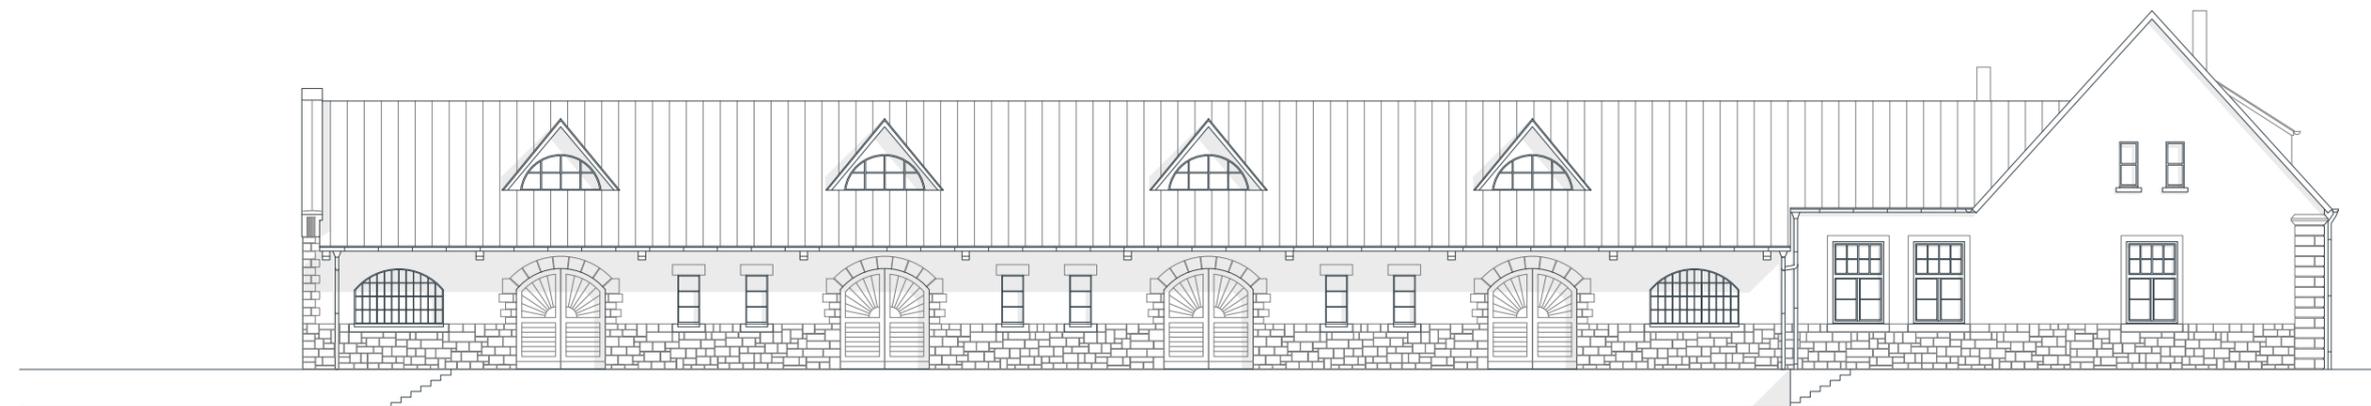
Zollabfertigung mit Zollschuppen, Nord-Ost-Fassade, 1904 M 1:200
